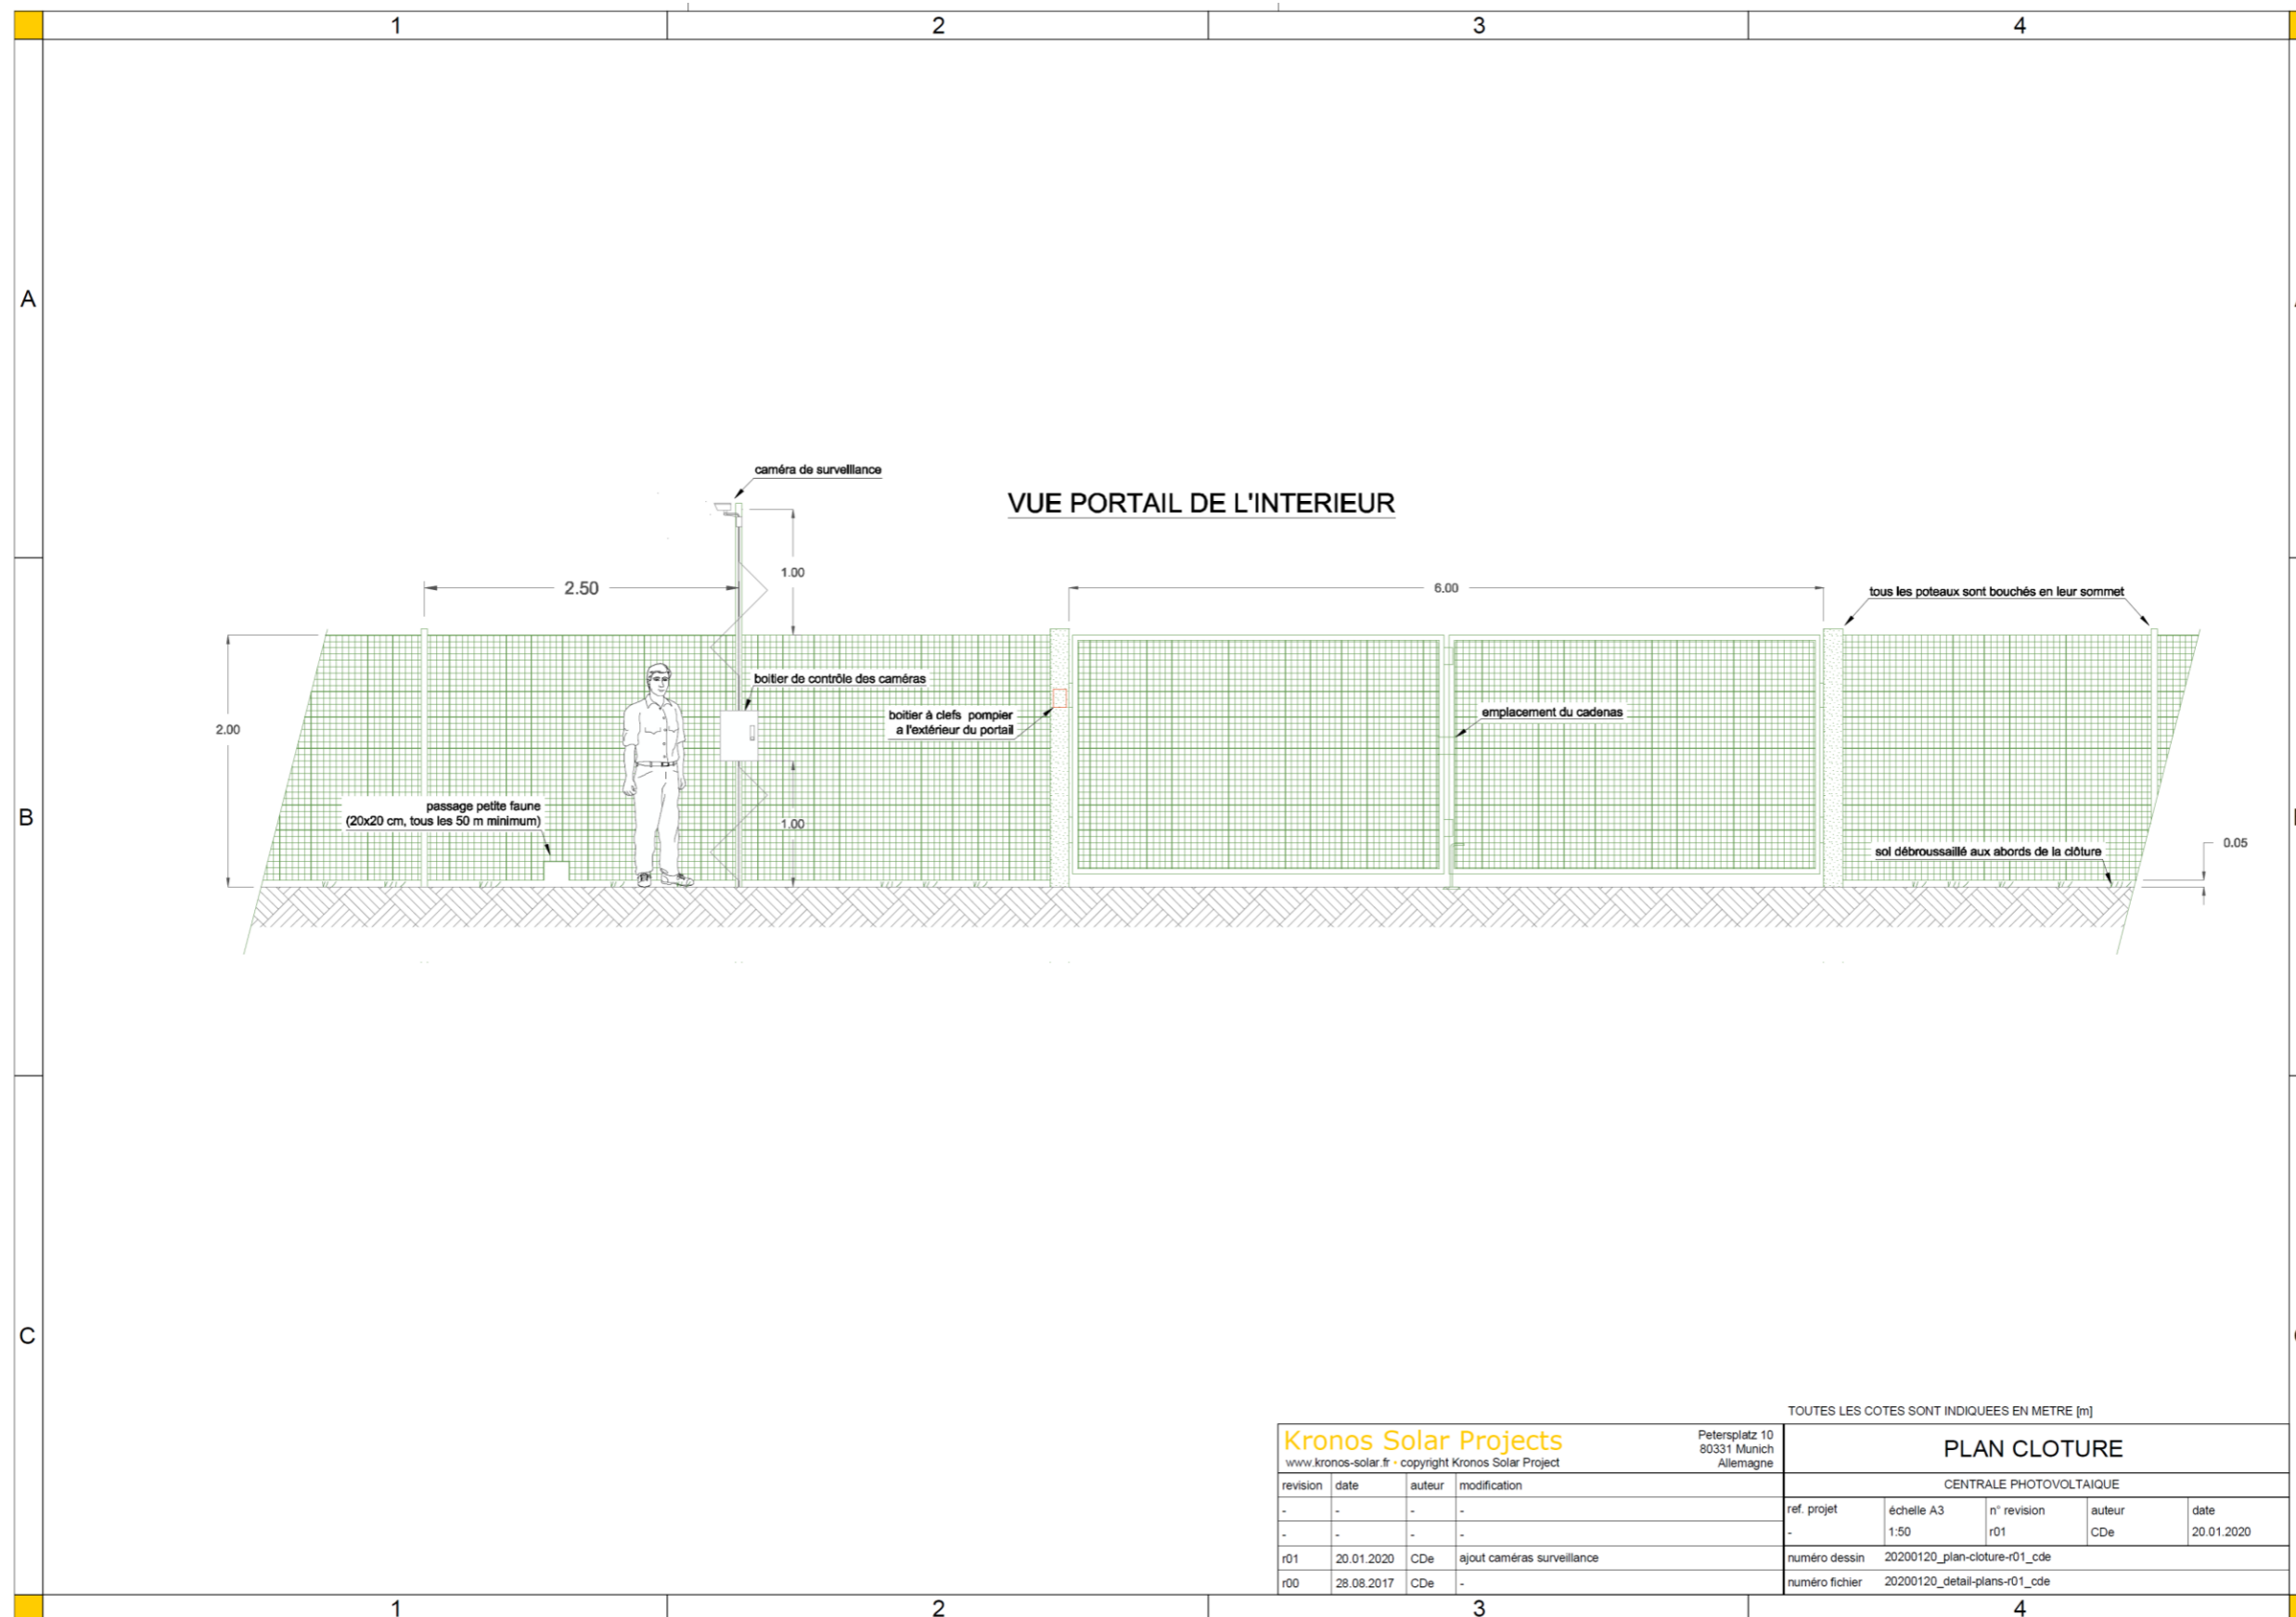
Plan de la clôture située au Nord, au Sud et à l'Est du parc photovoltaïque (Source : Porteur de projet)
